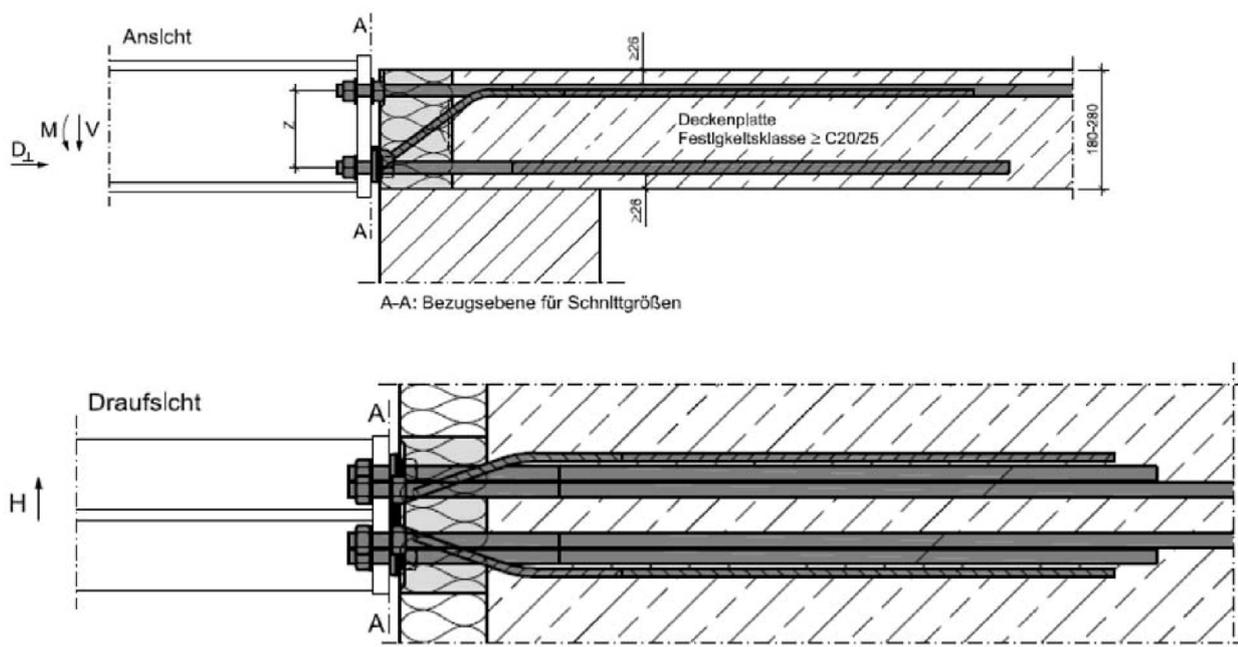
und 74: Schöck Isokorb® XT Typ SK-MM2-VV2, Schnittgrößendefinition
